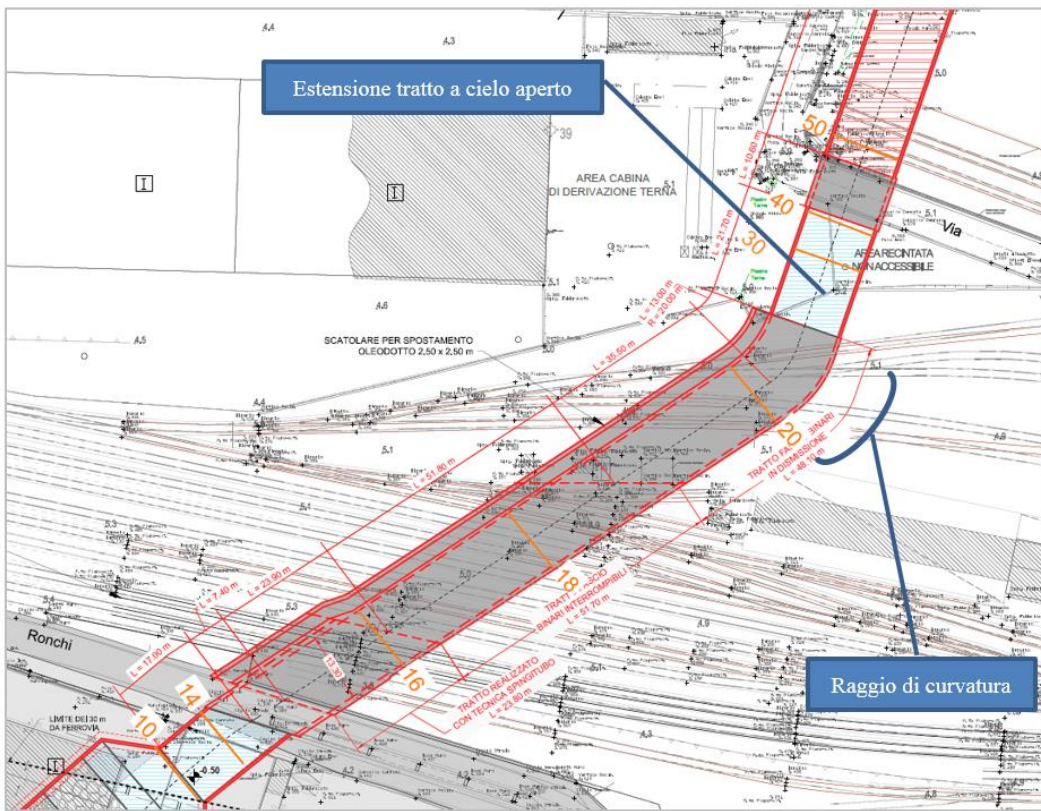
Planimetria progetto preliminare in corrispondenza dell'attraversamento del parco ferroviario
